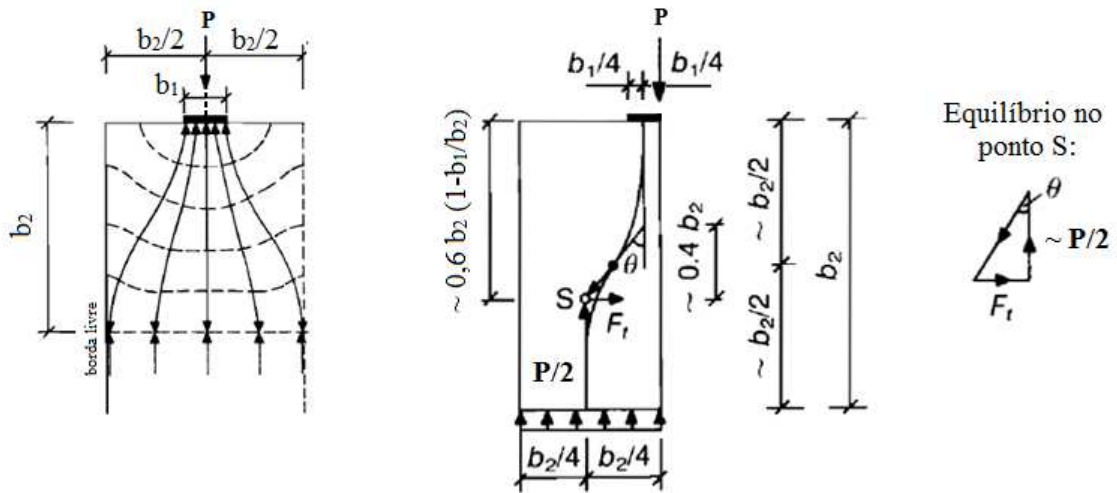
Separação longitudinal da laje de concreto em ensaios com Perfobond.
